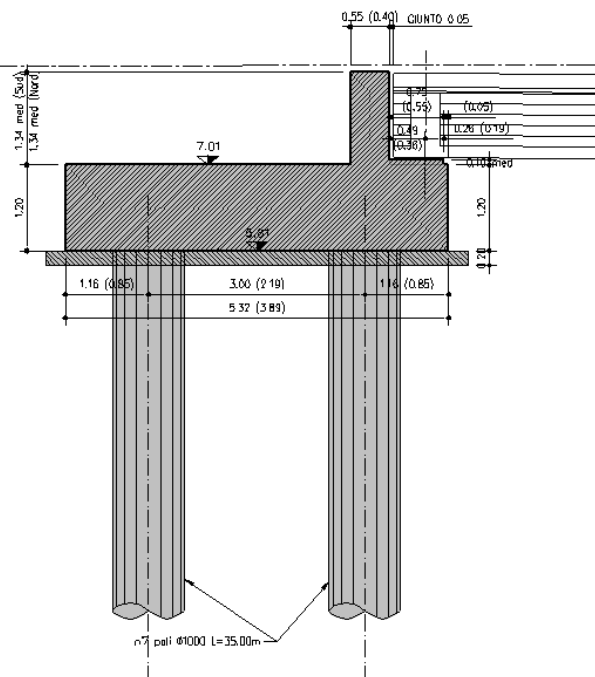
Sezione longitudinale spalla in ampliamento
